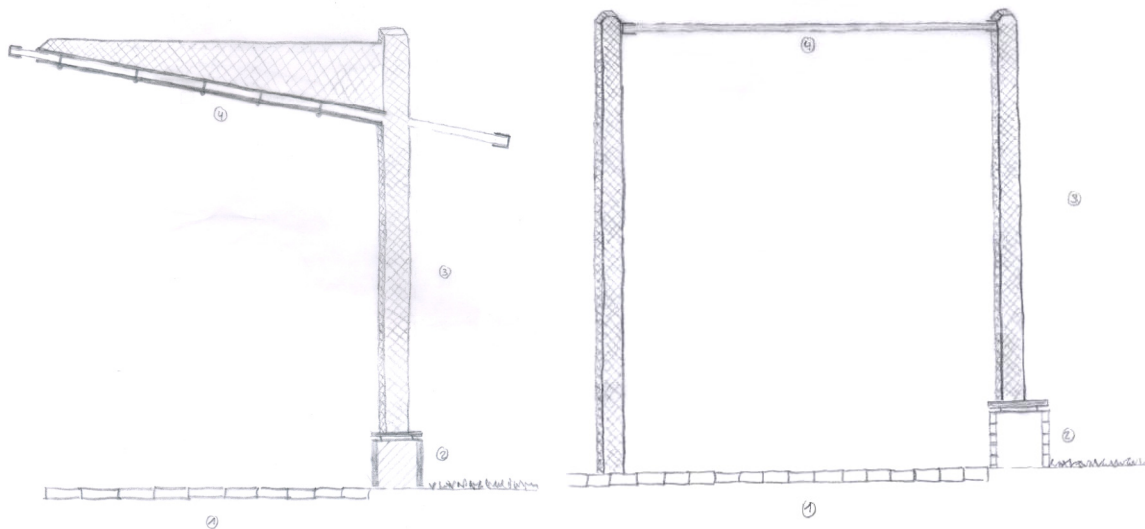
und 28 Skizzen Überdachung der Außenklassenzimmer (1: Betonpflaster; 2: Sitzmauer; 3: Stahlträger; 4: Glasdach)
